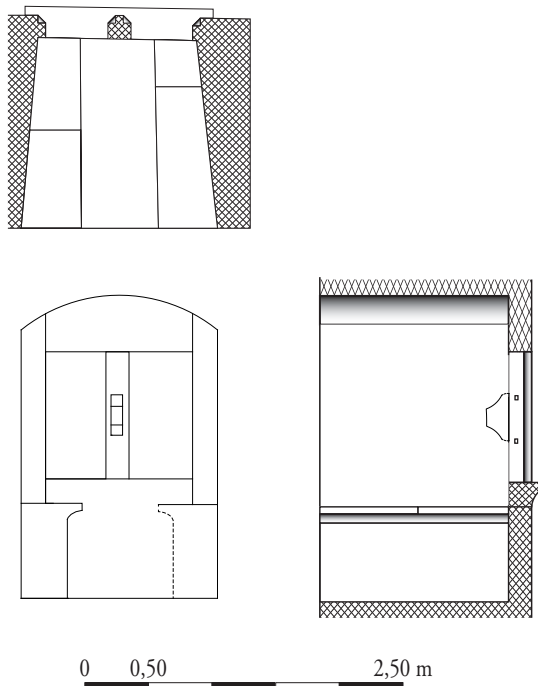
Plan, élévation et coupe de la fenêtre UM1-3-UC3
